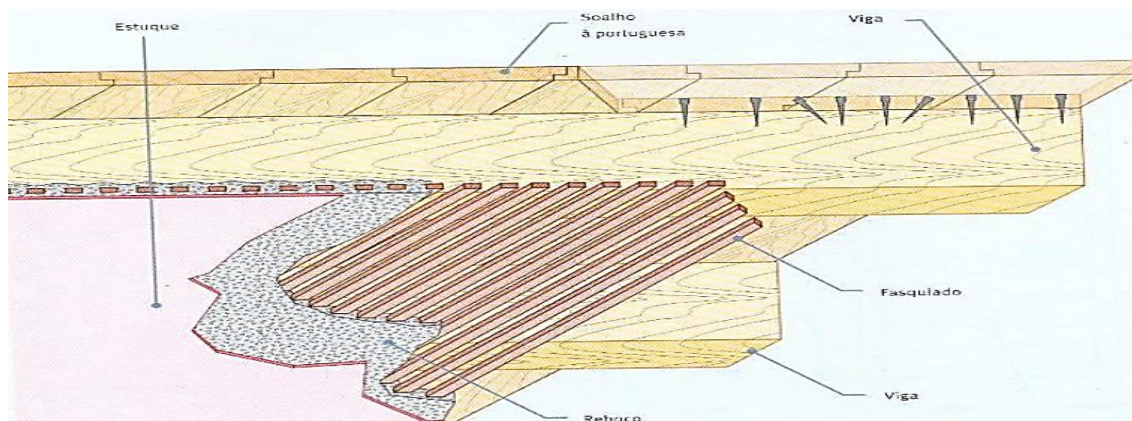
Esquema de um pavimento de madeira (Andrade, 2011)
